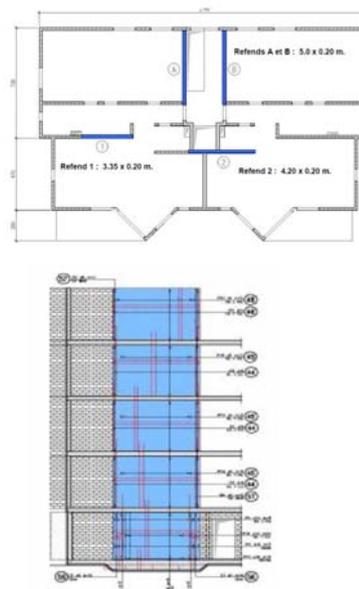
Fünfstöckiges Wohnhaus mit Grundrissplan und eingezeichneten erdbebensichereren Mauern (Quelle: Roberto Peruzzi, Kurmann & Cretton, 2005).
